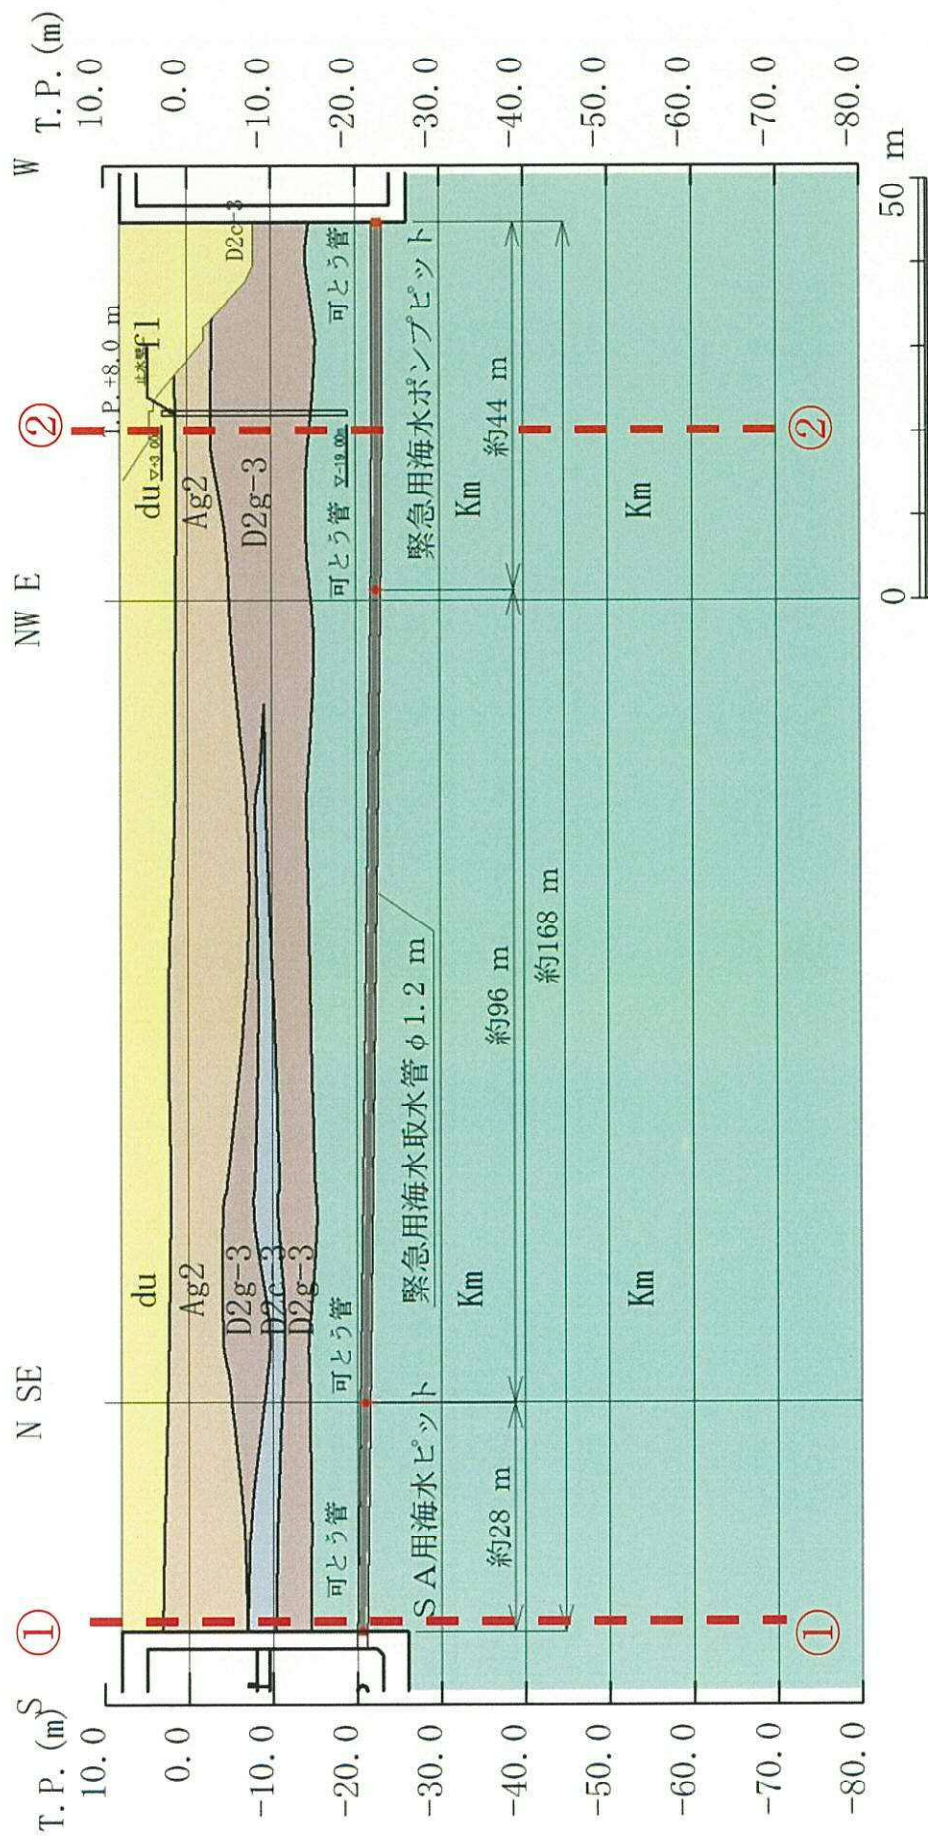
緊急用海水取水管 縦断面図 (A-A 断面)
